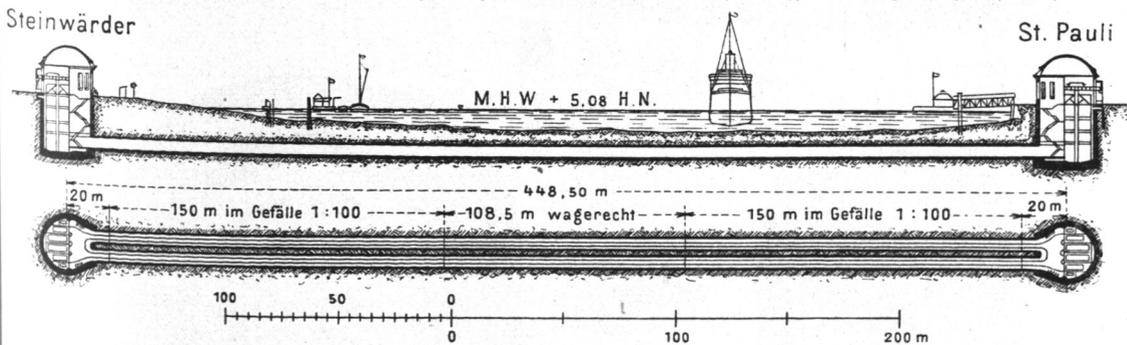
und 237. Längsdurchschnitt und Tunnelgrundriß.
